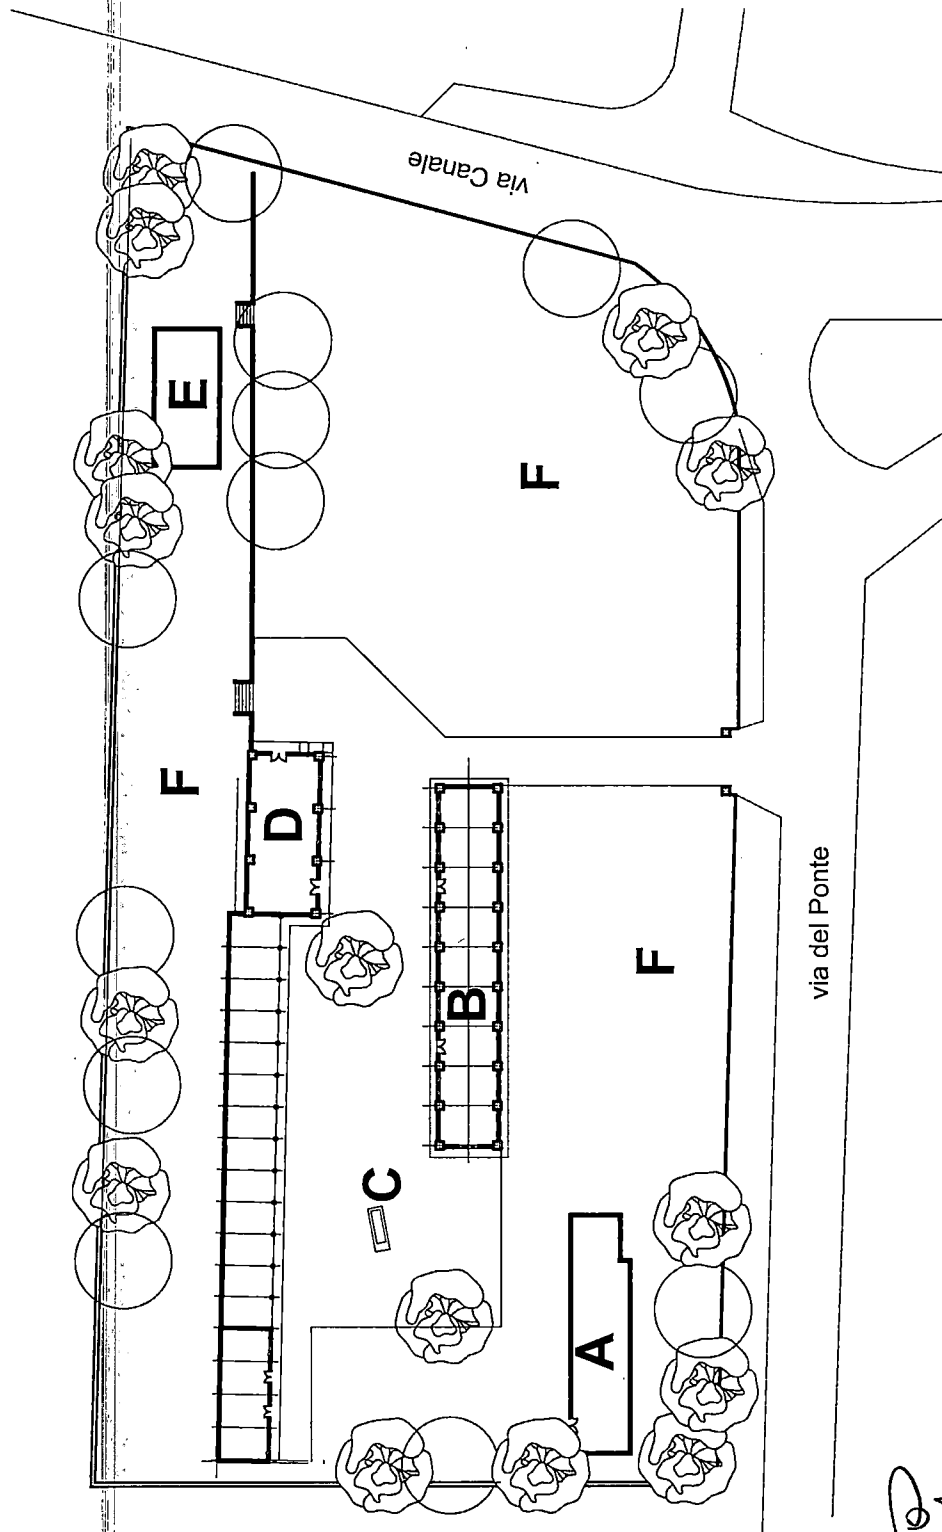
Planimetria del Ex Distaccamento Vedette
